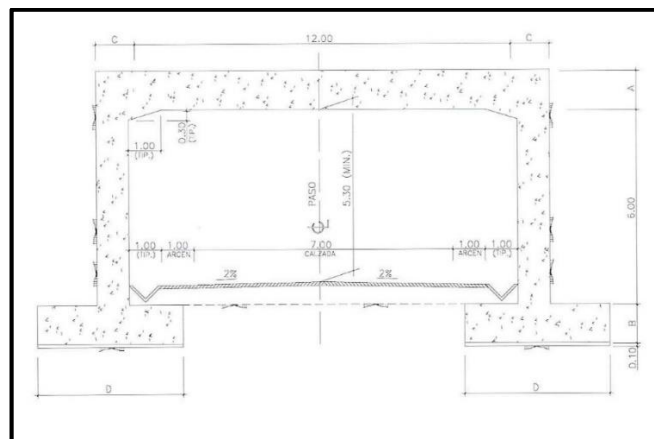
16. Sección pórtico en paso inferior de carretera
